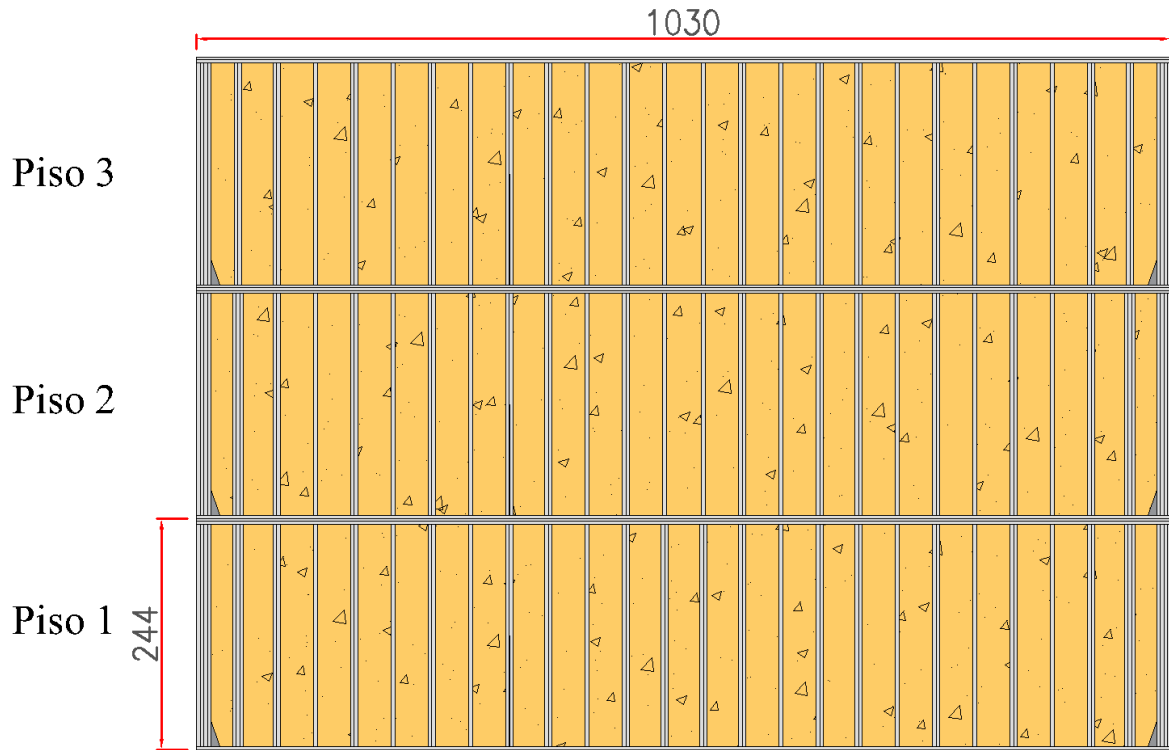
Elevación muro M3 (medidas en centímetros).
